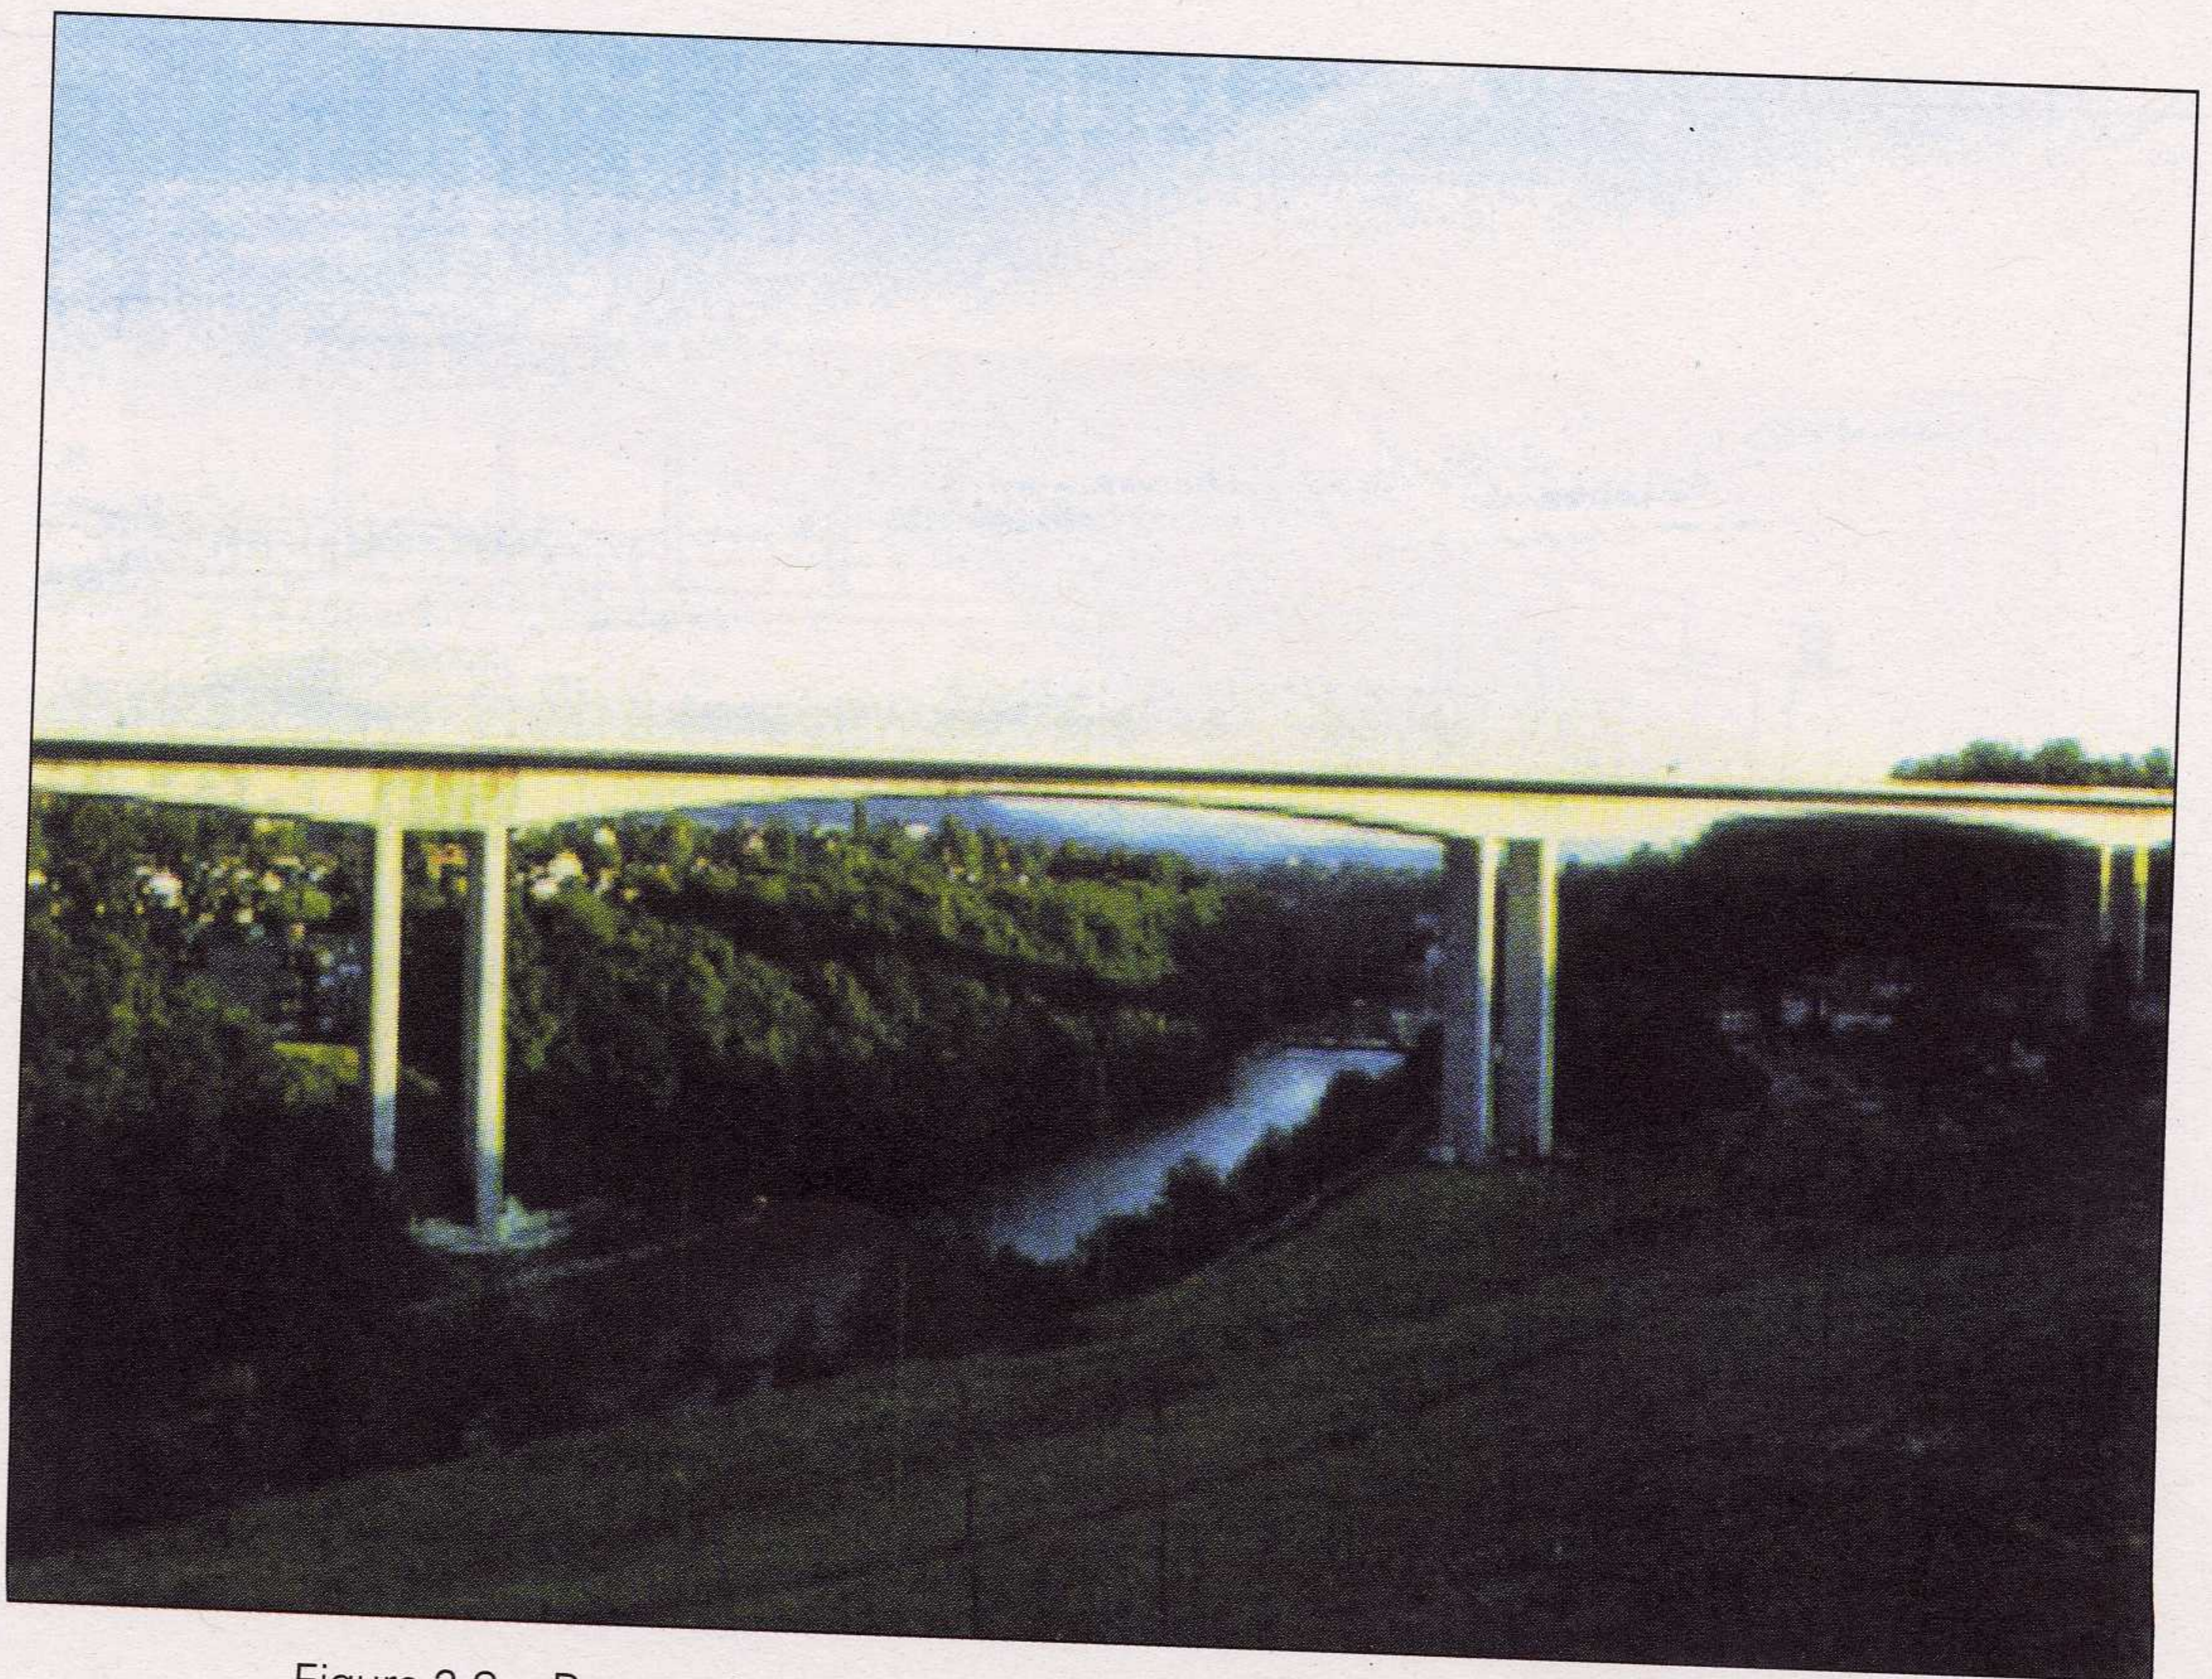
Puente de voladizos sucesivos con pilas empotradas en tablero
